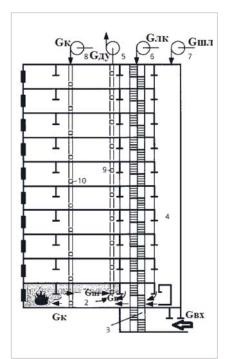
Расчетная схема работы противодымной вентиляции при пожаре на 1-м этаже многоэтажного здания
